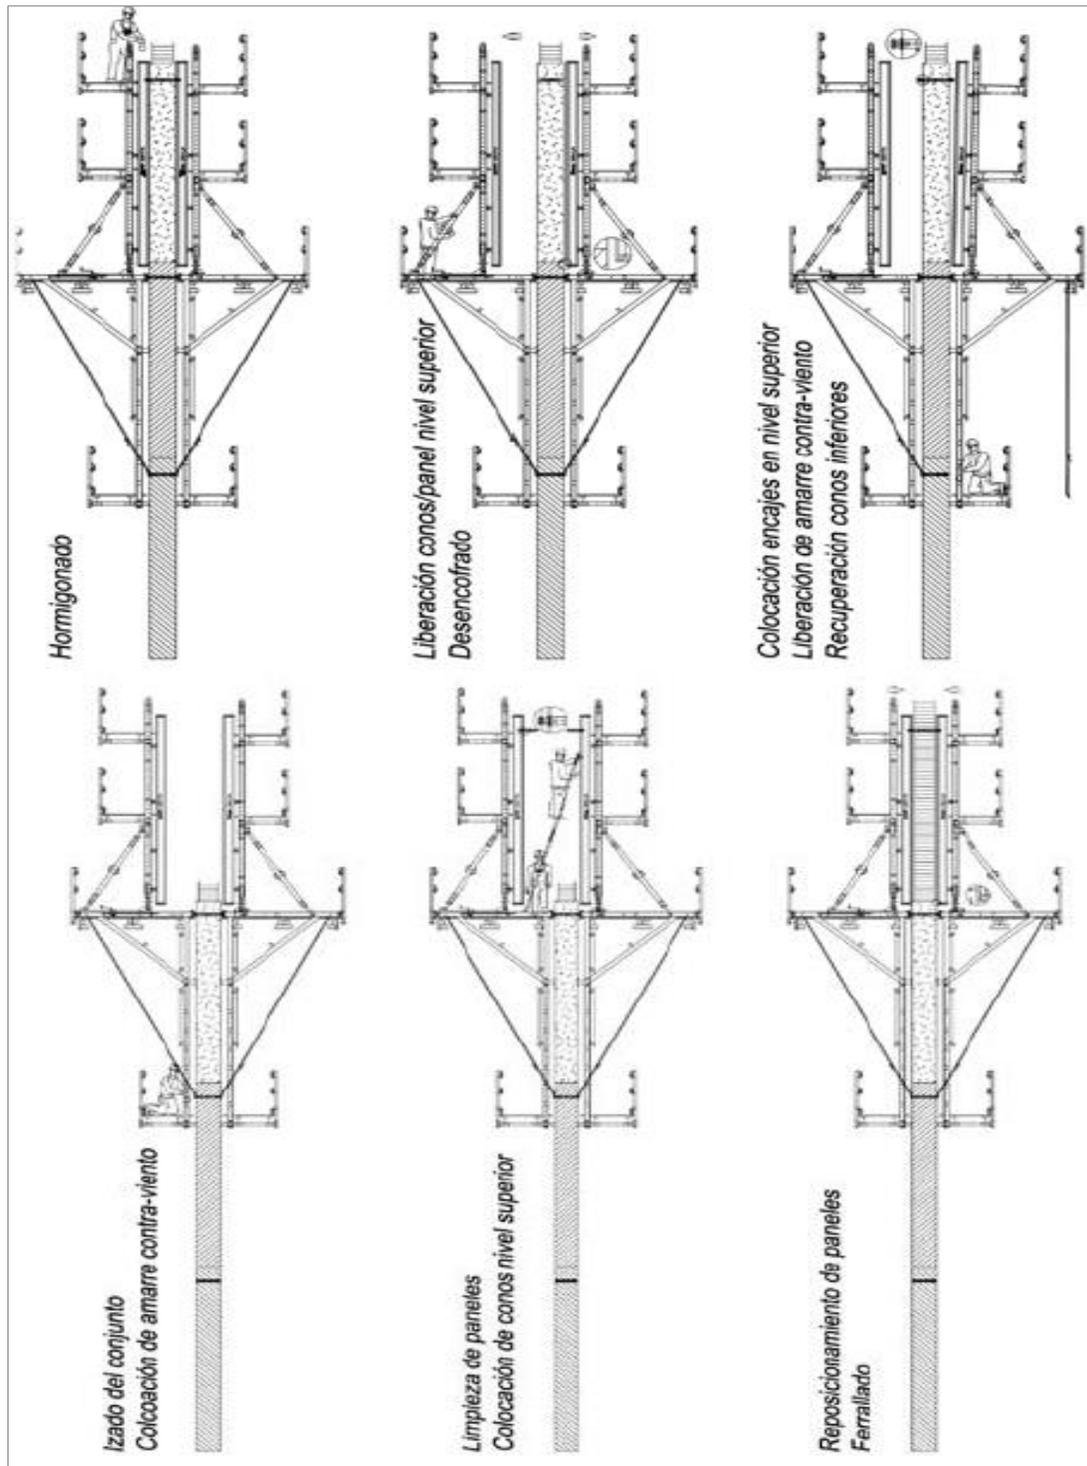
Proceso de trepado en sistemas de encofrado vertical trepante.
